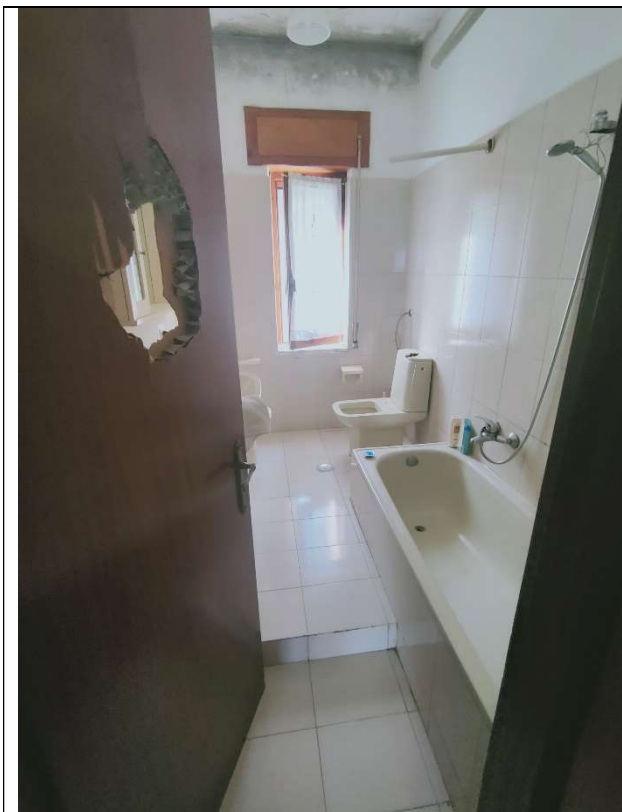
SERVIZI IGIENICI DEL PIANO PRIMO CON AFFACCIO FINISTRATO
